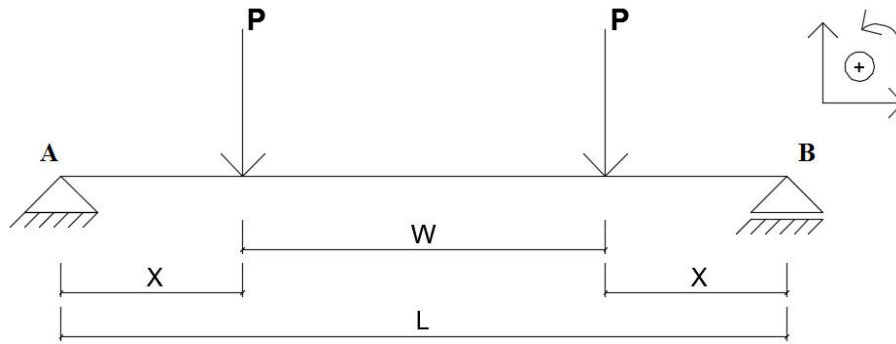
Sistema estrutural adotado na campanha experimental.
